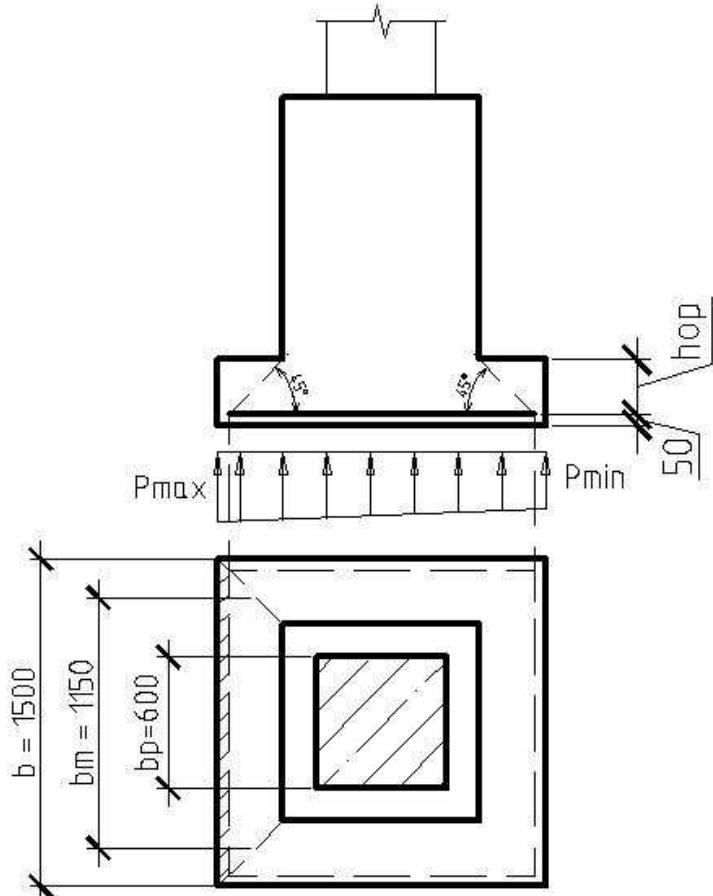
Схема к расчету низкого фундамента на продавливание под колонником
